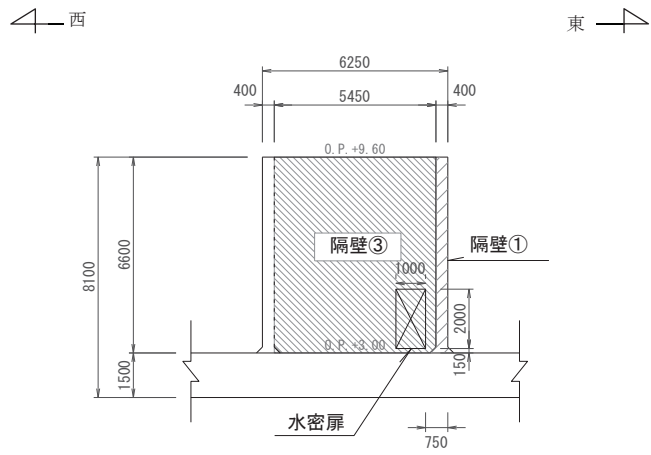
(3) 補機ポンプエリア断面図 (③—③断面)
